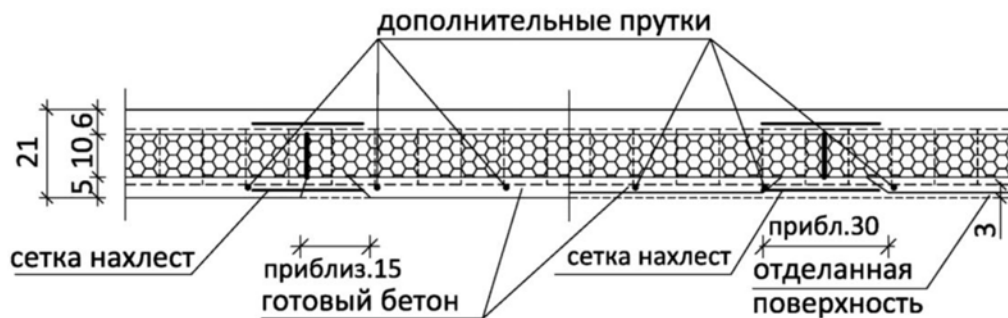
Панели перекрытий частично бетонированные на заводе с нижней стороны
